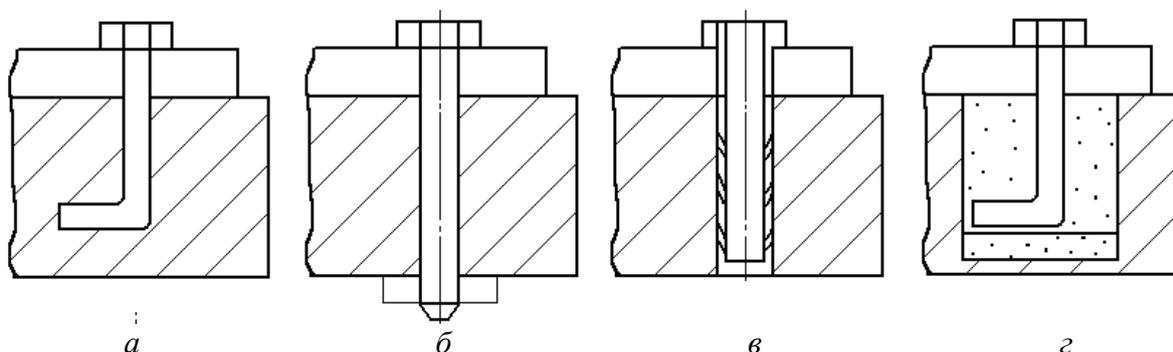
Виды фундаментных болтов: а – залитые в массив фундамента; б – съемные; в – устанавливаемые в готовые фундаменты; г – залитые в колодцах
